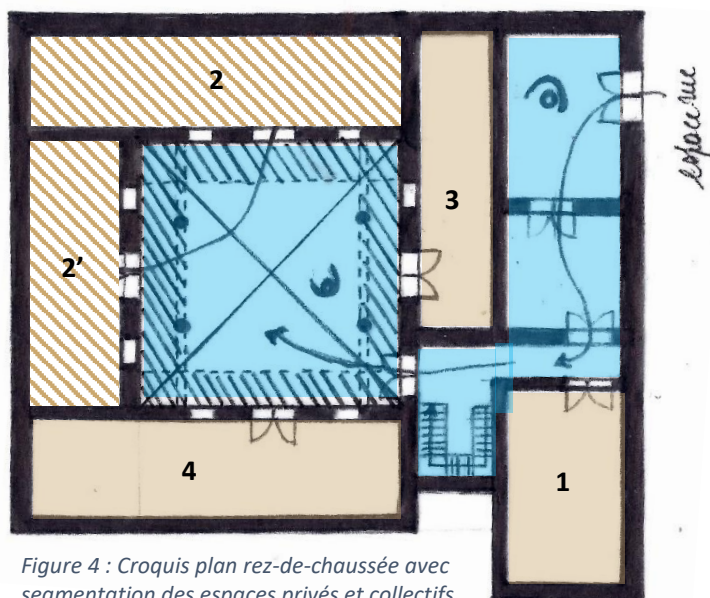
Croquis plan rez-de-chaussée avec segmentation des espaces privés et collectifs
